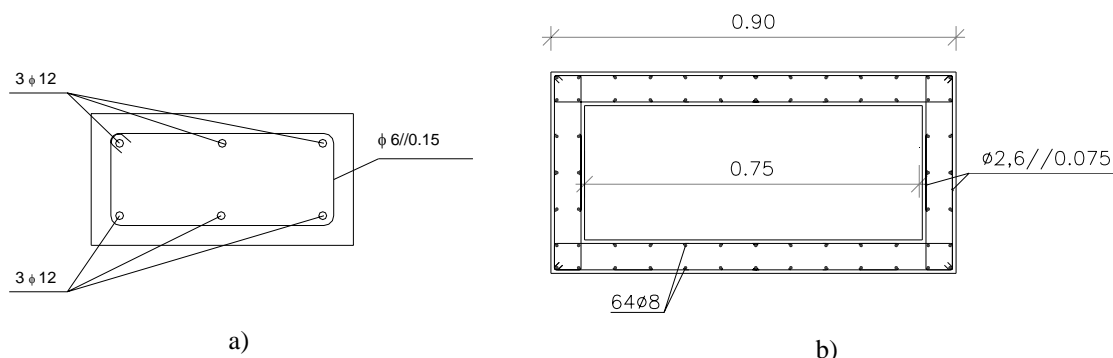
Secção transversal dos pilares ensaiados. a) PA1 com secção maciça; b) PO2 com secção oca.
